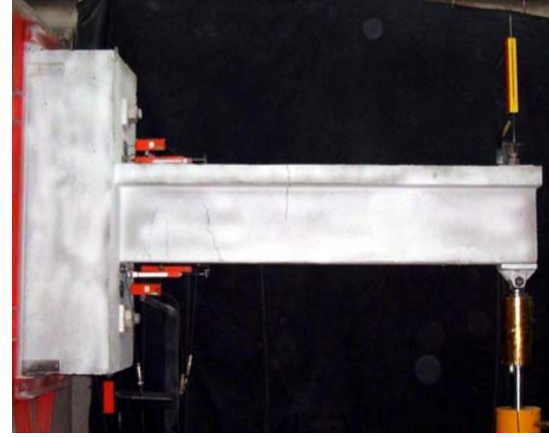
Kiriş-1 Kontrol Elemanı
